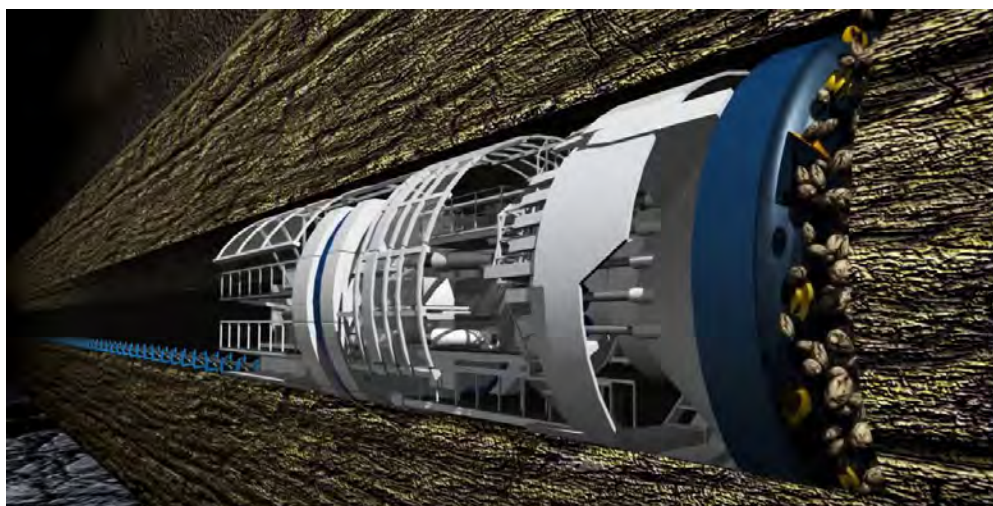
Schema excavare cu tehnologia Tunel Boring Machine (TBM)
